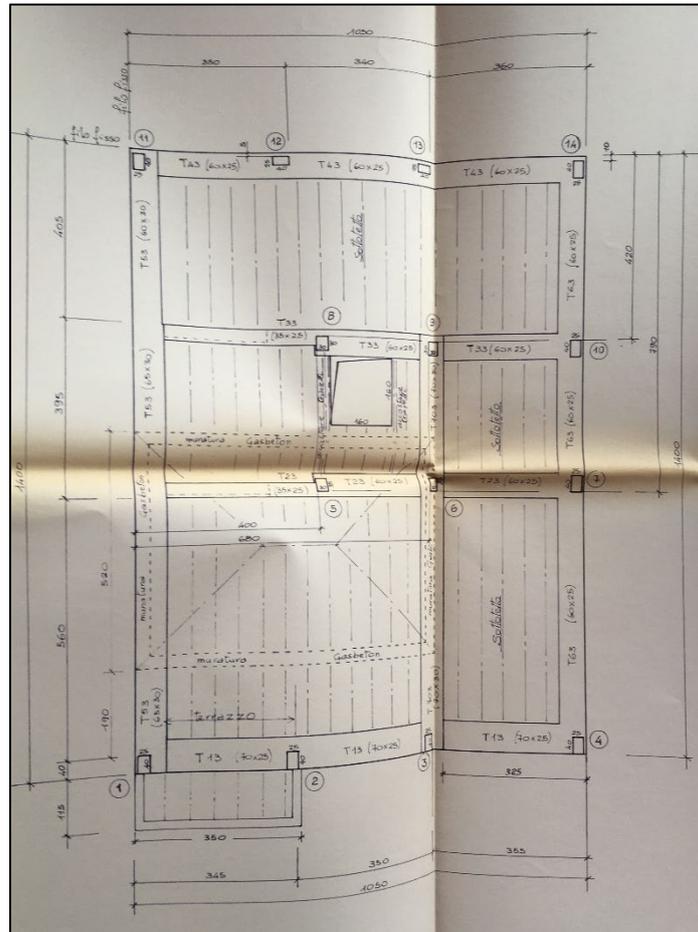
Pianta del quarto orizzontamento dei solai (sottotetto)
